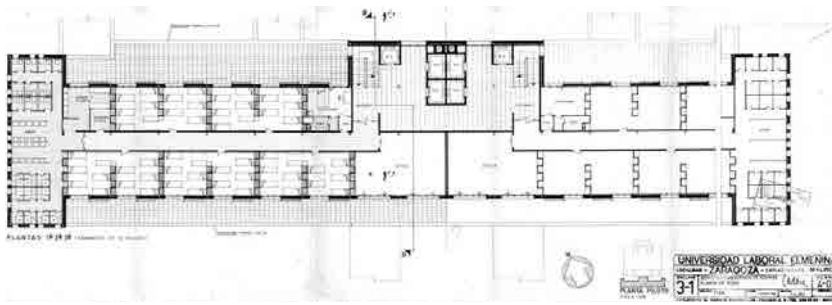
Residencias de la Universidad Laboral de Zaragoza. Planta tipo del edificio principal.
